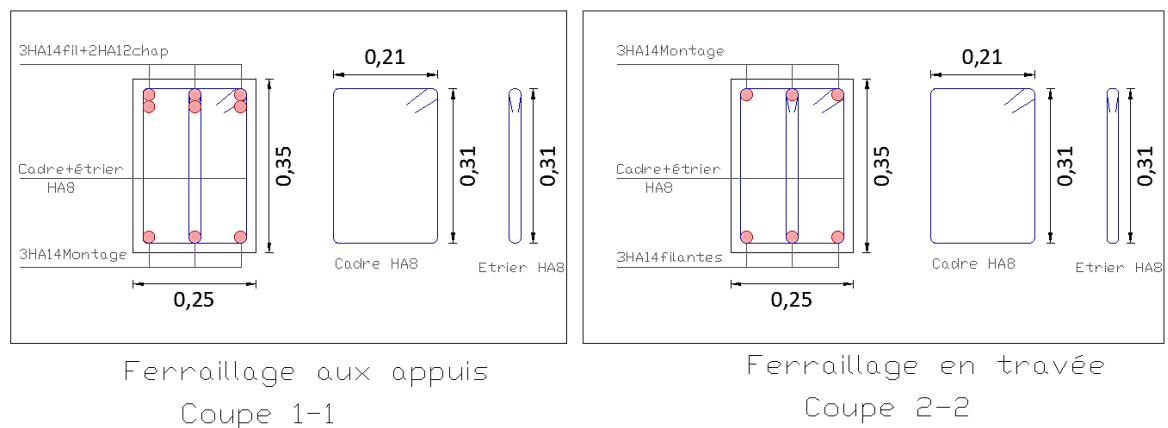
Ferrillage des poutres secondaires (25x35) cm2
